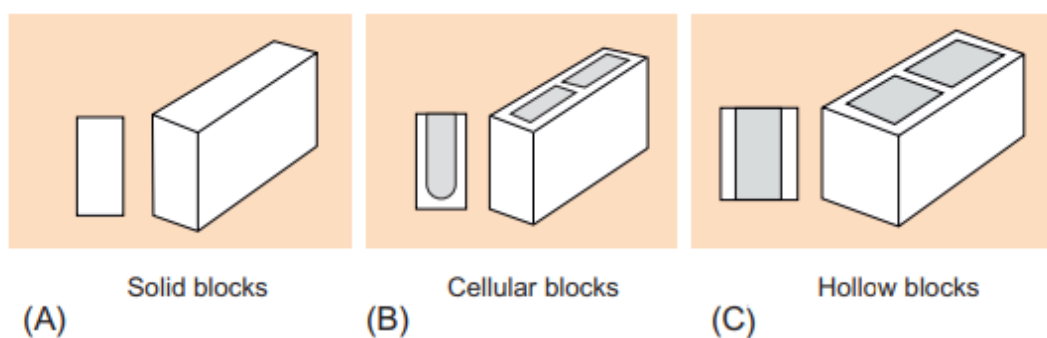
Tipos comunes de bloque. Fuente: (“Types of Masonry Walls in Building Construction,” n.d.)
